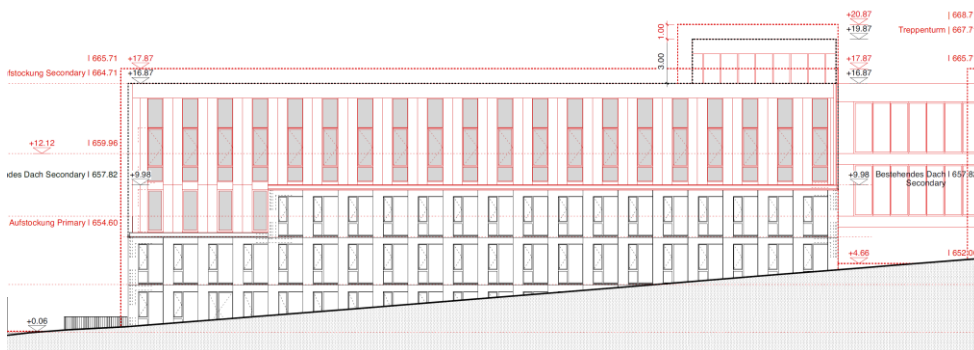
Secondary Building, Ansicht Strubenacher, Käferstein & Meister, 21.04.2022
